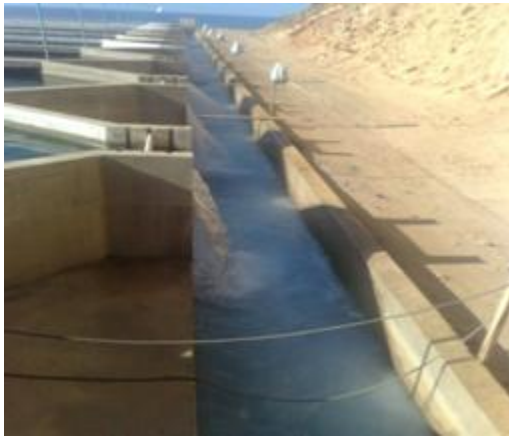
Versement de l'eau dans le canal collecteur secondaire
